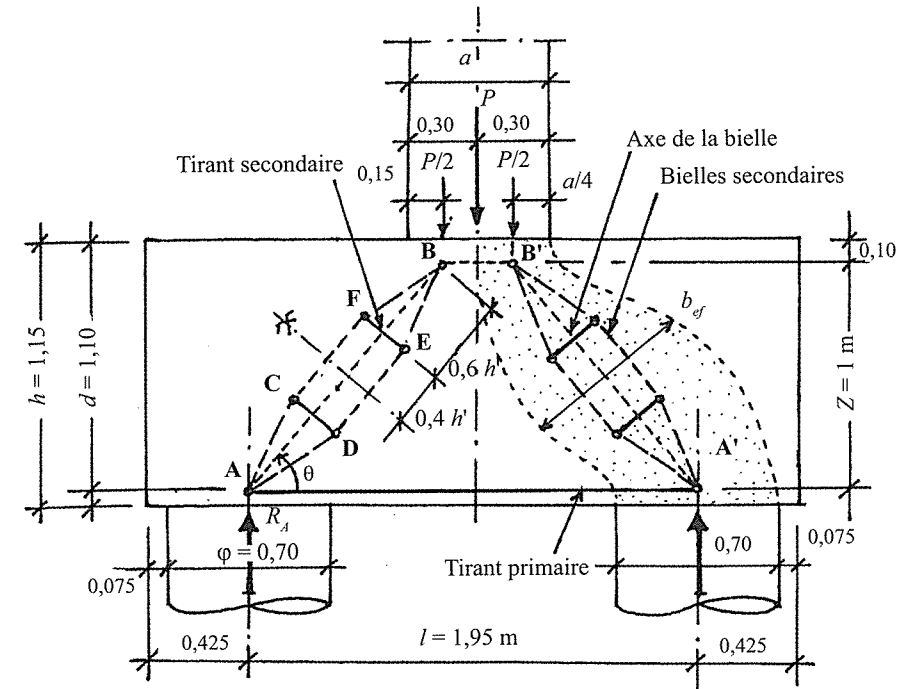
Élévation de la semelle sur pieux et modélisation bielles-tirants.
